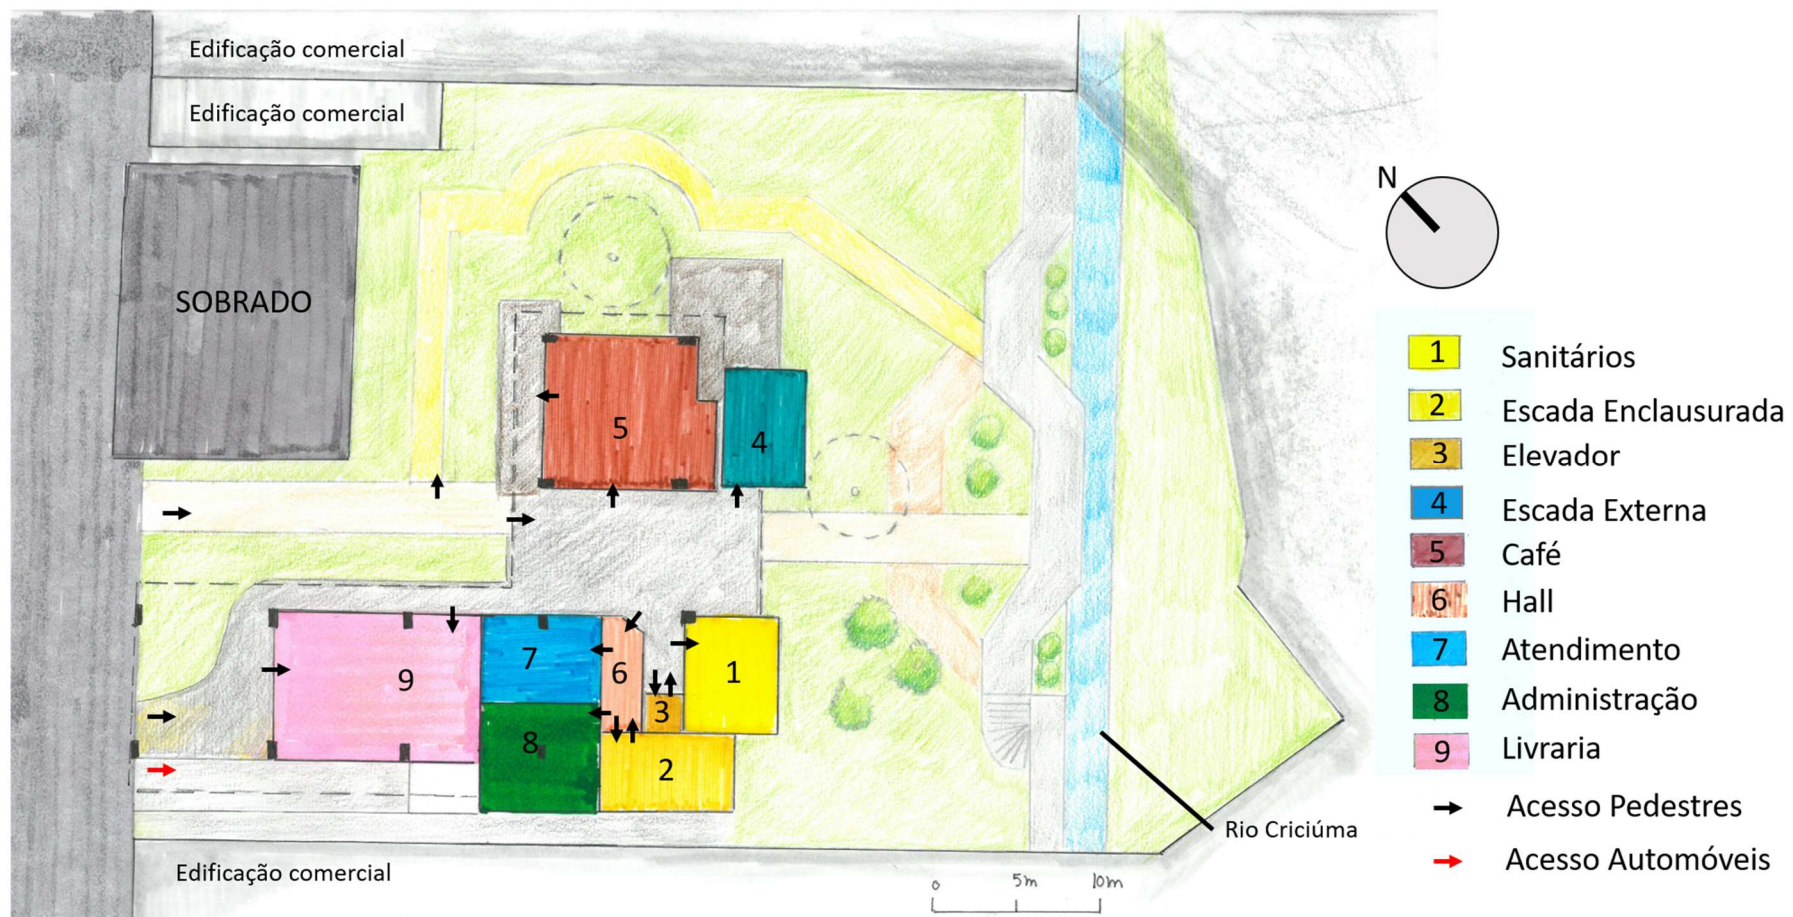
planta baixa térreo. Fonte: Arquivo pessoal
